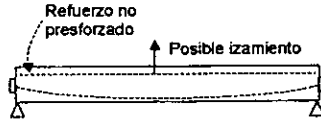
Refuerzo no presforzado para fortalecer una viga precolada durante su manejo y erección
